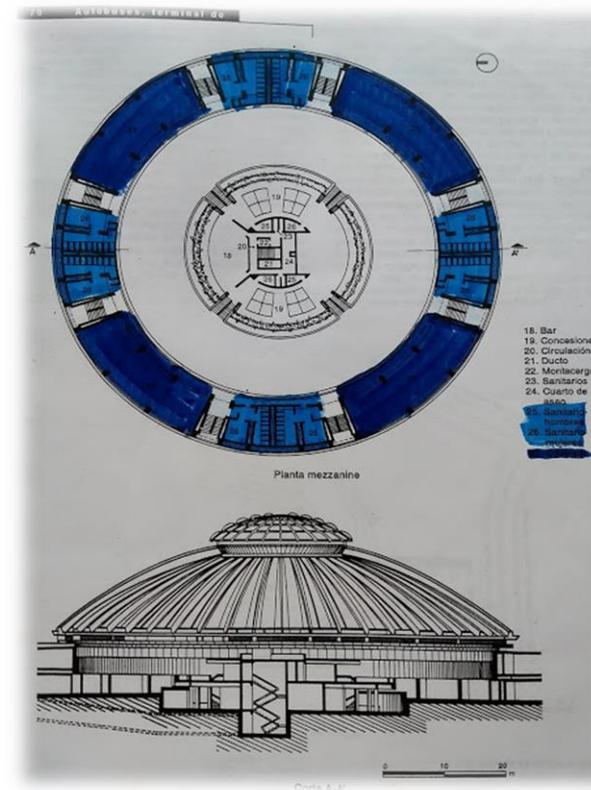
PLANTA MEZZANINE TAPO Y CORTE
